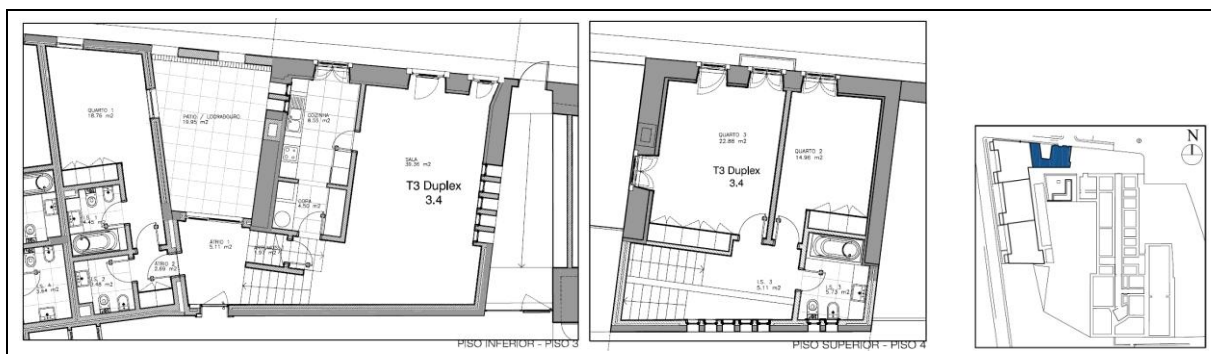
Planta e localização das habitações T3 Duplex [98]
